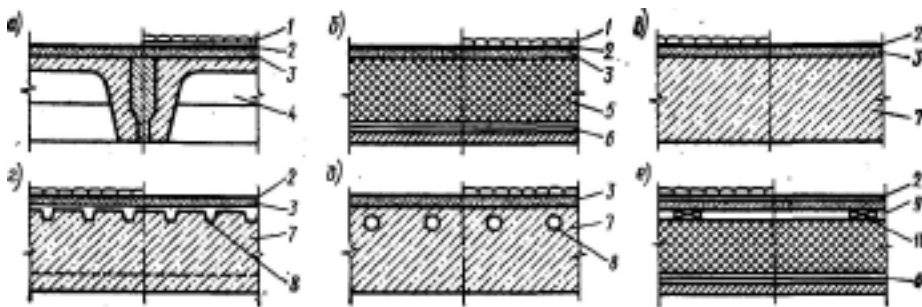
Основные типы покрытий с железобетонными плитами и рулонными кровлями:
